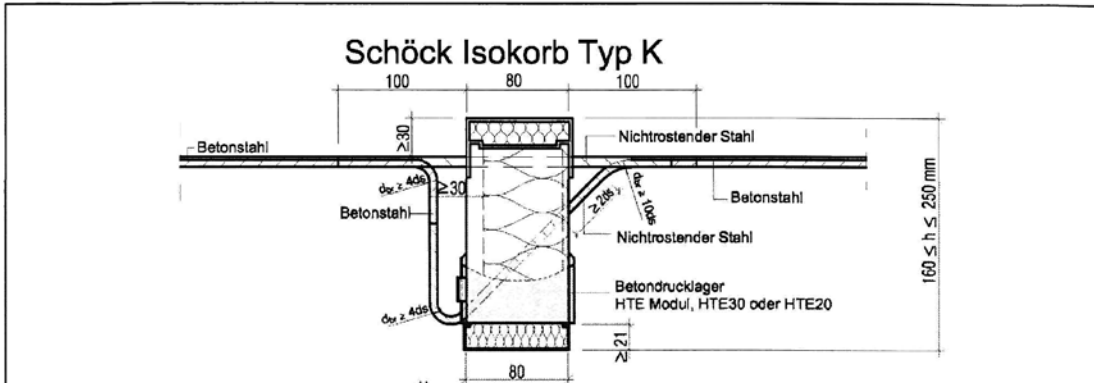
Schöck Isokorb Typ K¹⁾ mit integrierter Aufhängebewehrung gem. Abschn. 3.3.1
